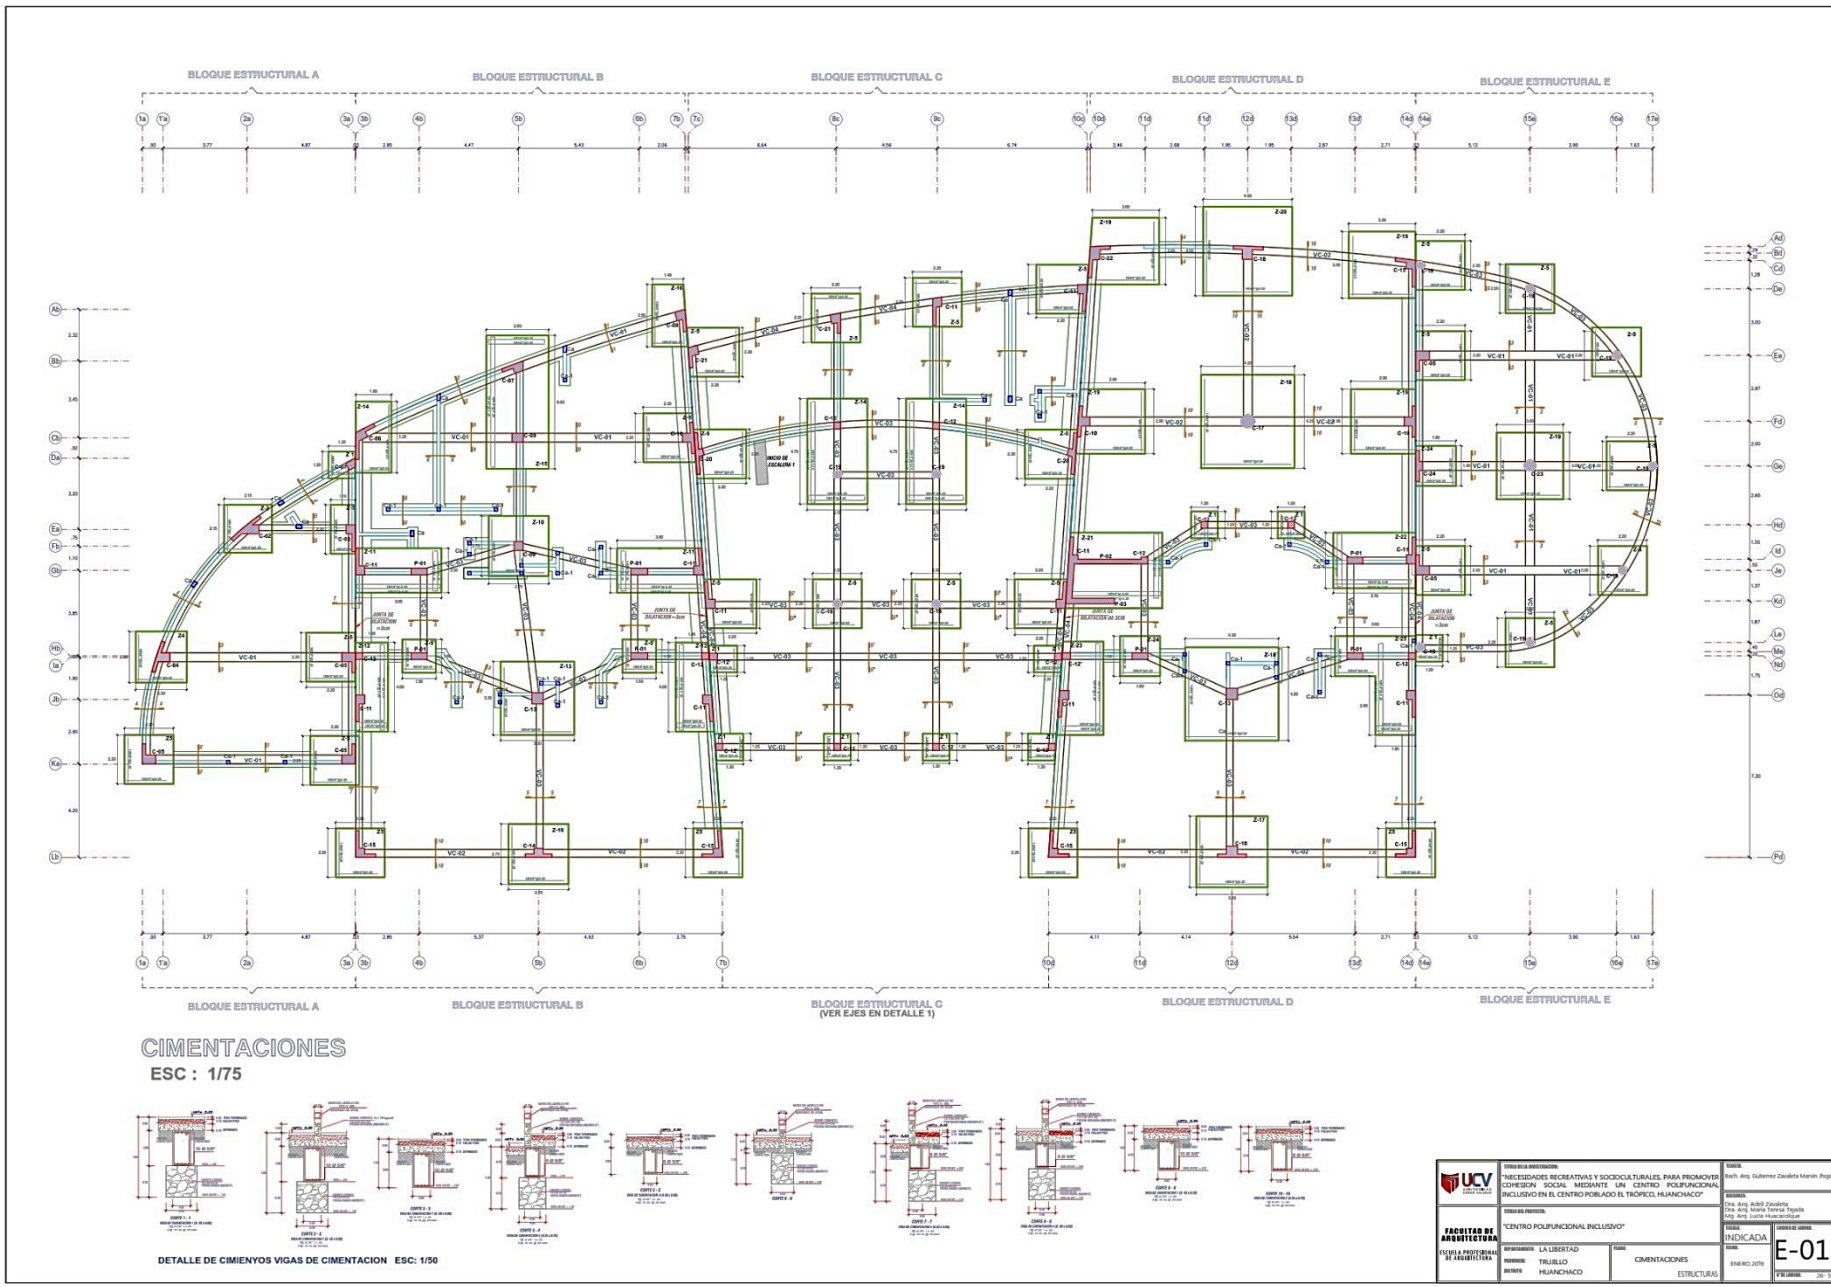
Plano Estructural de cimentaciones: E-01. Fuente: Propia (2018)
